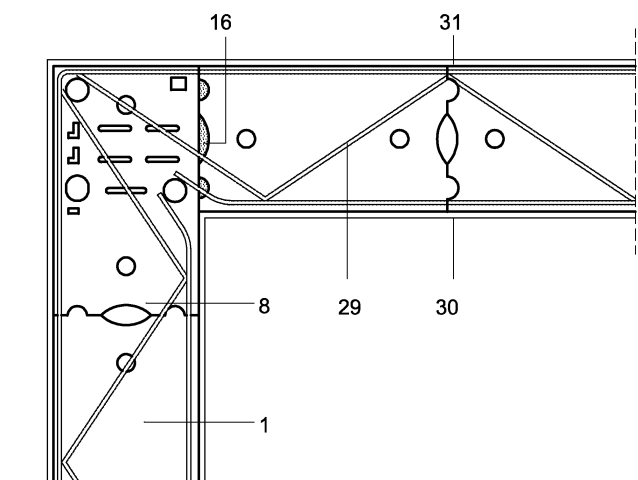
Encuentro en esquina hilada impar. Muro portante. Bloque de longitud 50.
